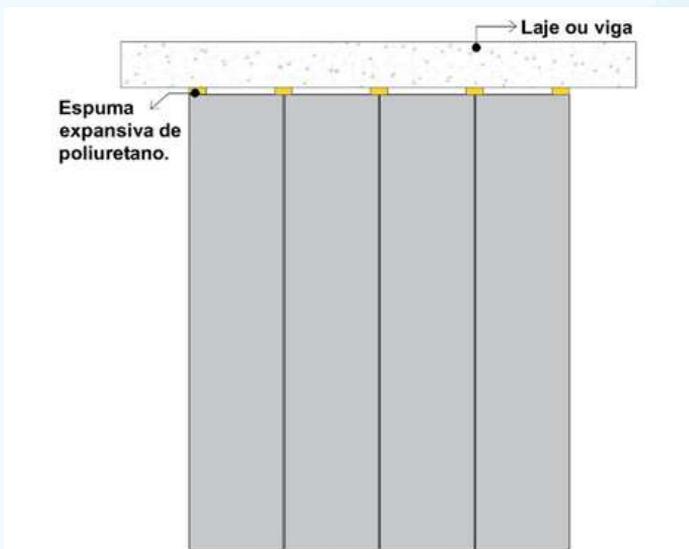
exemplo de aplicação de pontos de espuma expansiva no fundo de laje ou viga.
